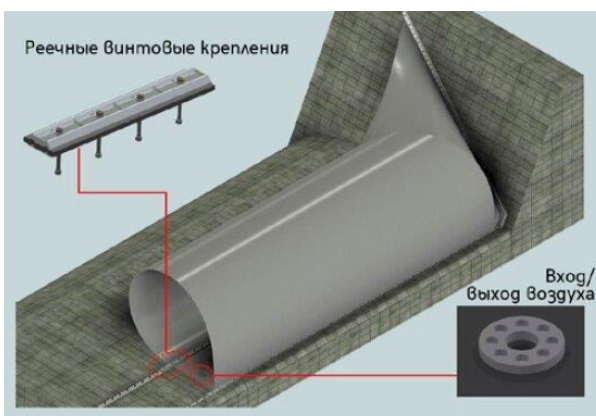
Схема крепления мягкой наполняемой плотины
